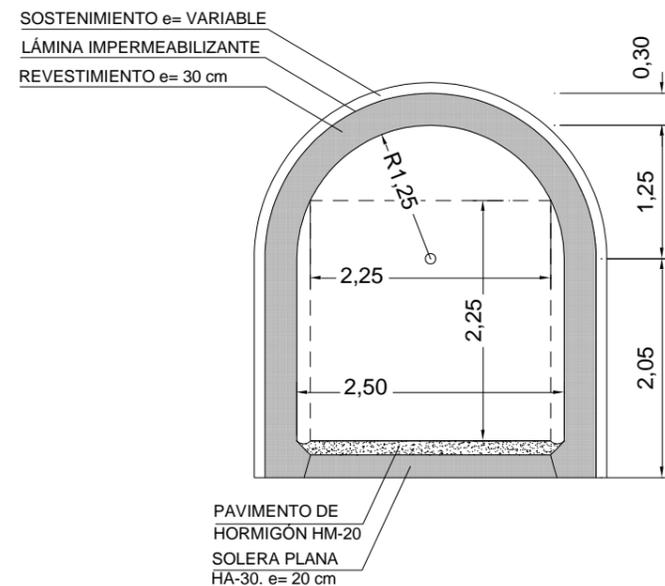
Sección tipo galería de emergencia Túnel de Colmenares
